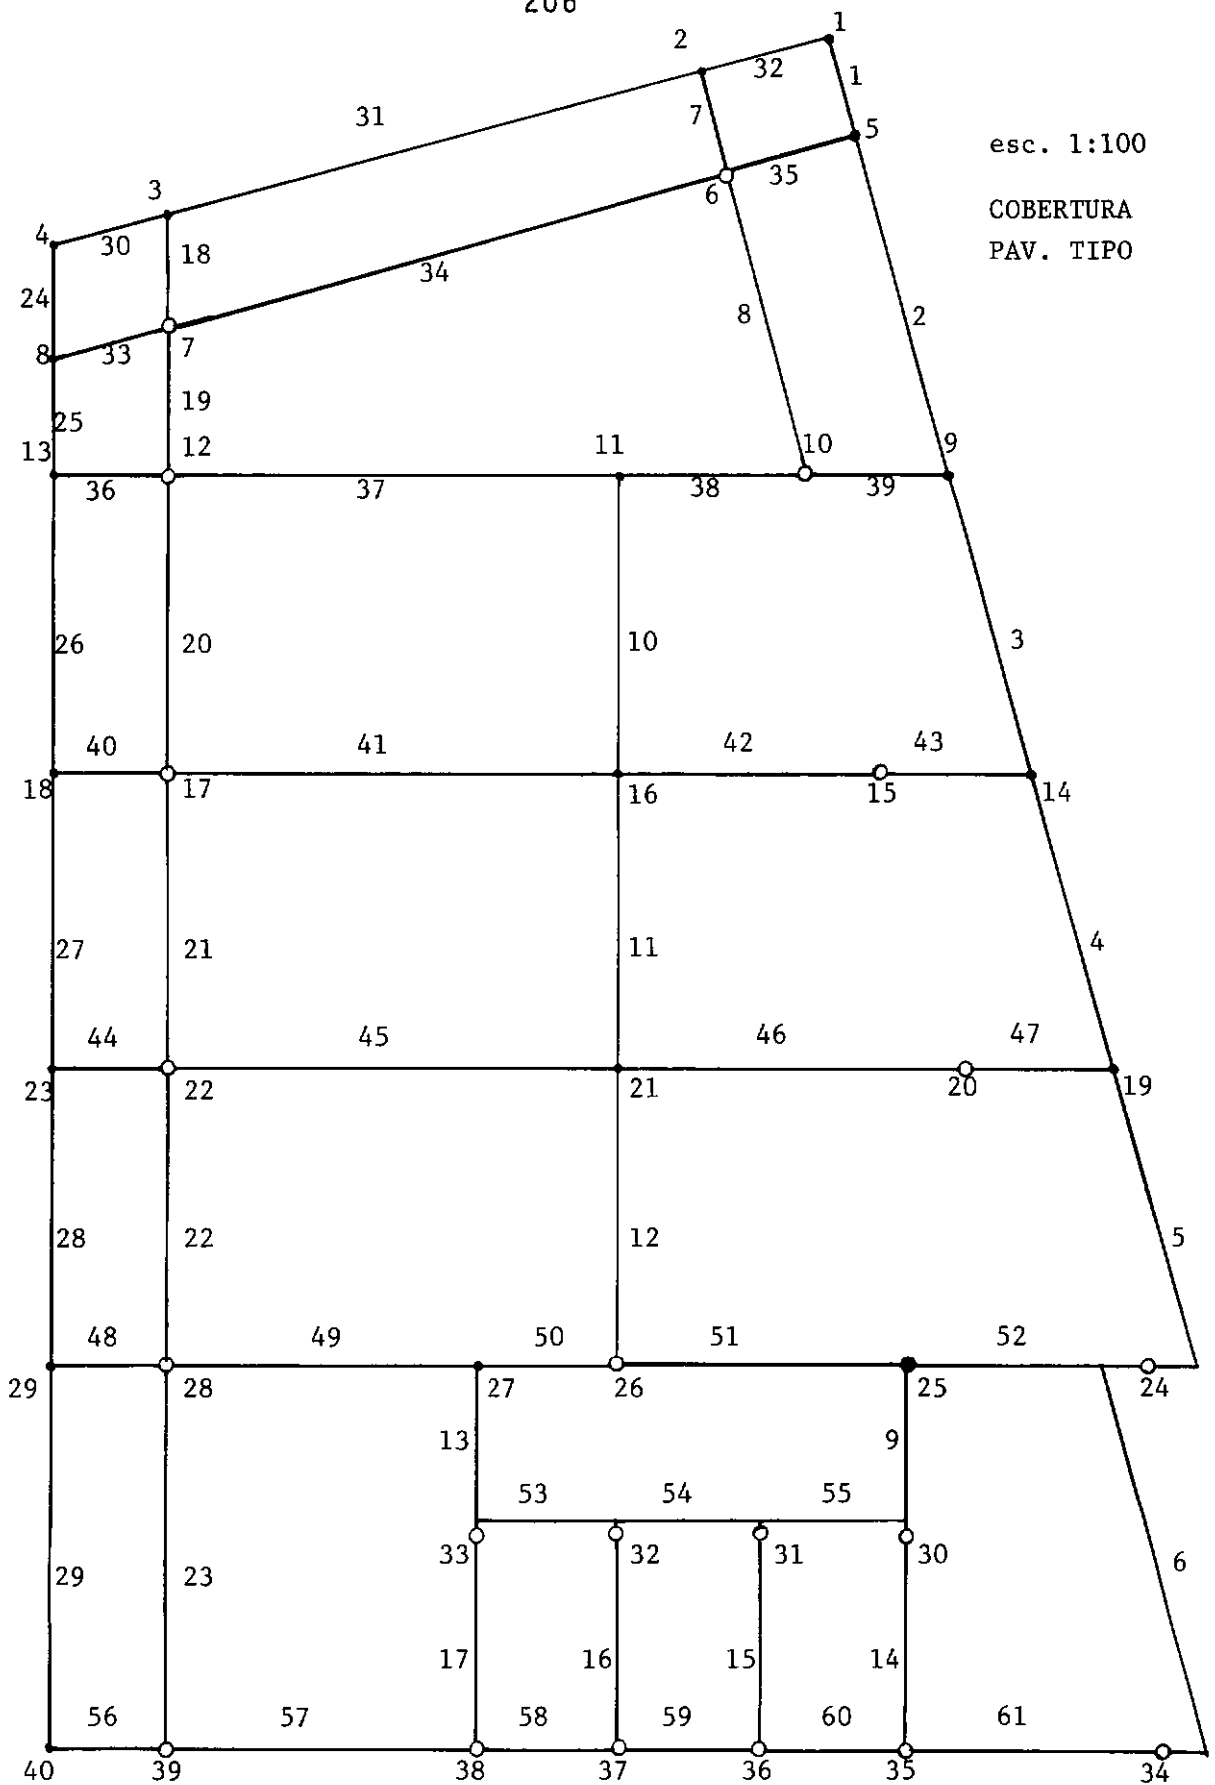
Planta de Locação dos Pontos Nodais.
